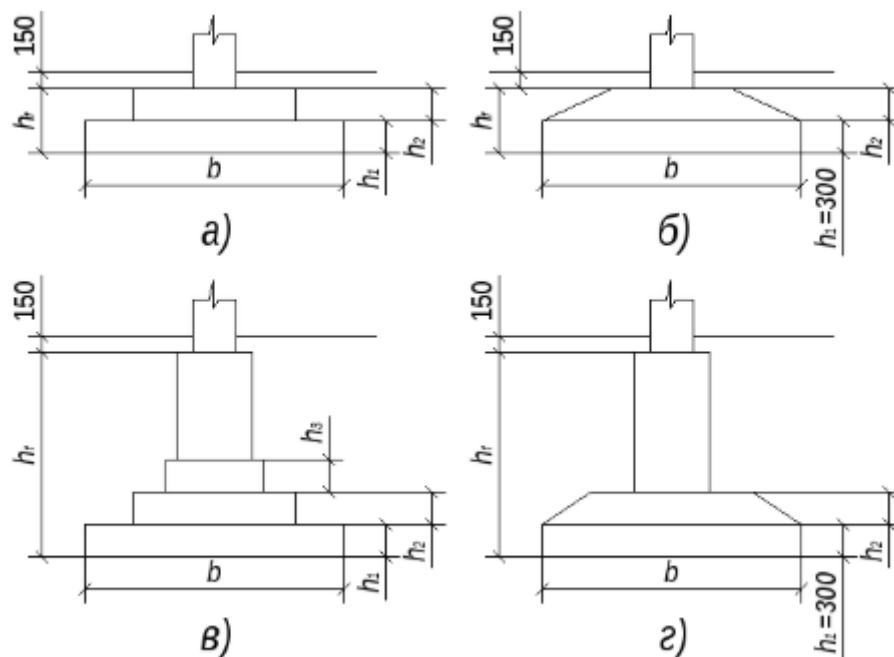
Стовпчасті монолітні залізобетонні фундаменти
